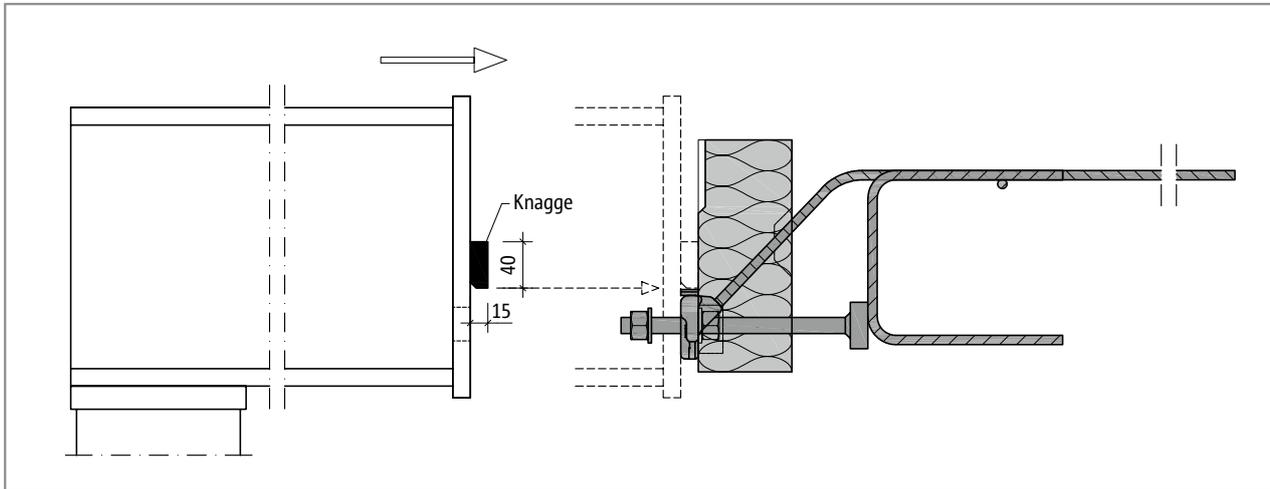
Schöck Isokorb® T Typ SQ: Montage des Stahlträgers
